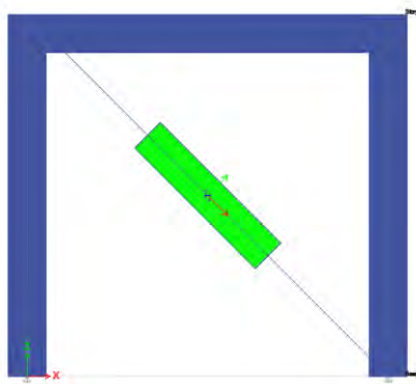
19 Modelación de los elementos estructurales: marco de concreto y muro de mampostería puntal equivalente.
